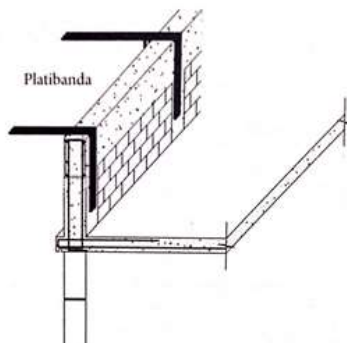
Balancim apoiado em platibanda de pilares e viga de concreto armado engastado em laje maciça. [2]
